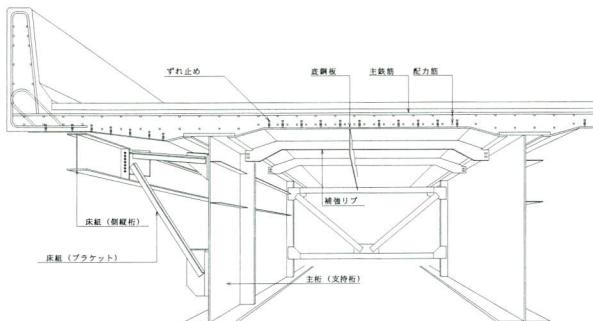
鋼・コンクリート複合床版の構造概要（将来完成形）
